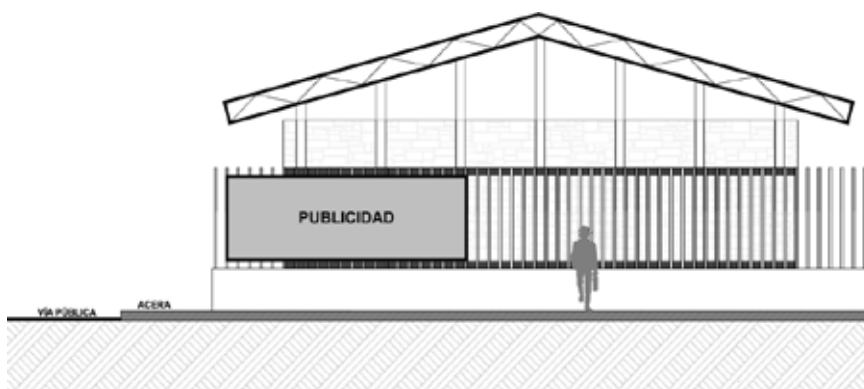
Tipo L - Lona. - Publicidad o propaganda exterior Lona en cerramiento o fachada
